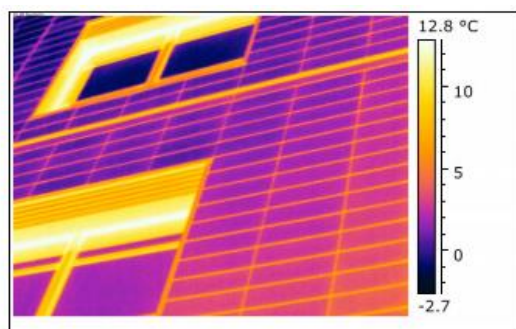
Fachada Sureste. (MCDONOUGHPARTNERS, 2014)
